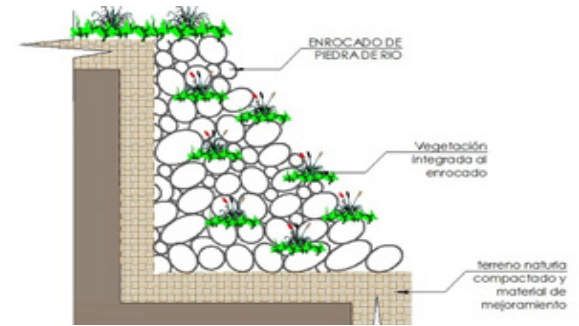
Sección del muro propuesto en la zona de senderos tropicales. Fuente: Grupo de la Maestría de Paisaje.
